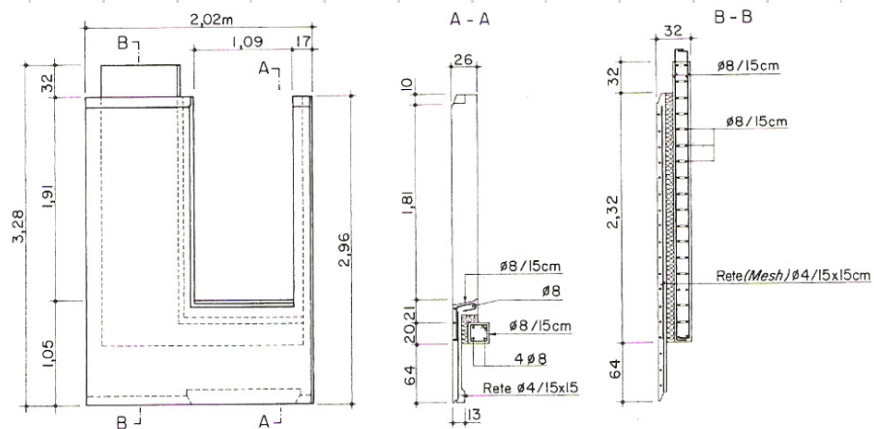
Vista di un pannello di facciata e sezione con la disposizione dell' armatura ordinaria
